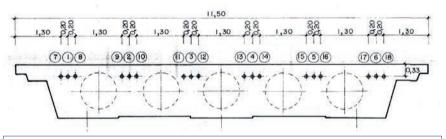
Sección transversal de la losa pretensada (apoyos pilas)
